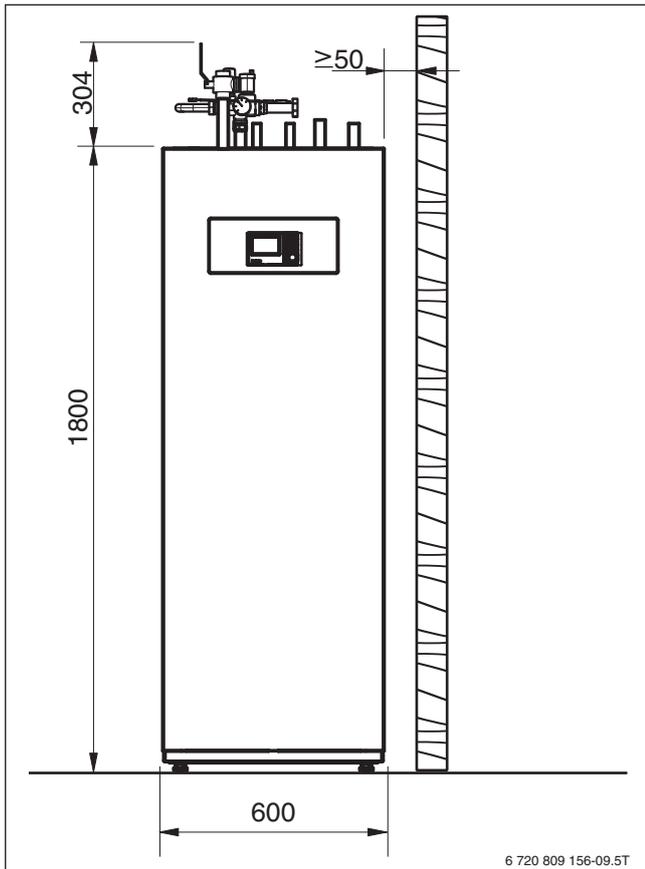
Abmessungen und Mindestabstände des Towers, Frontalansicht (Maße in mm)
